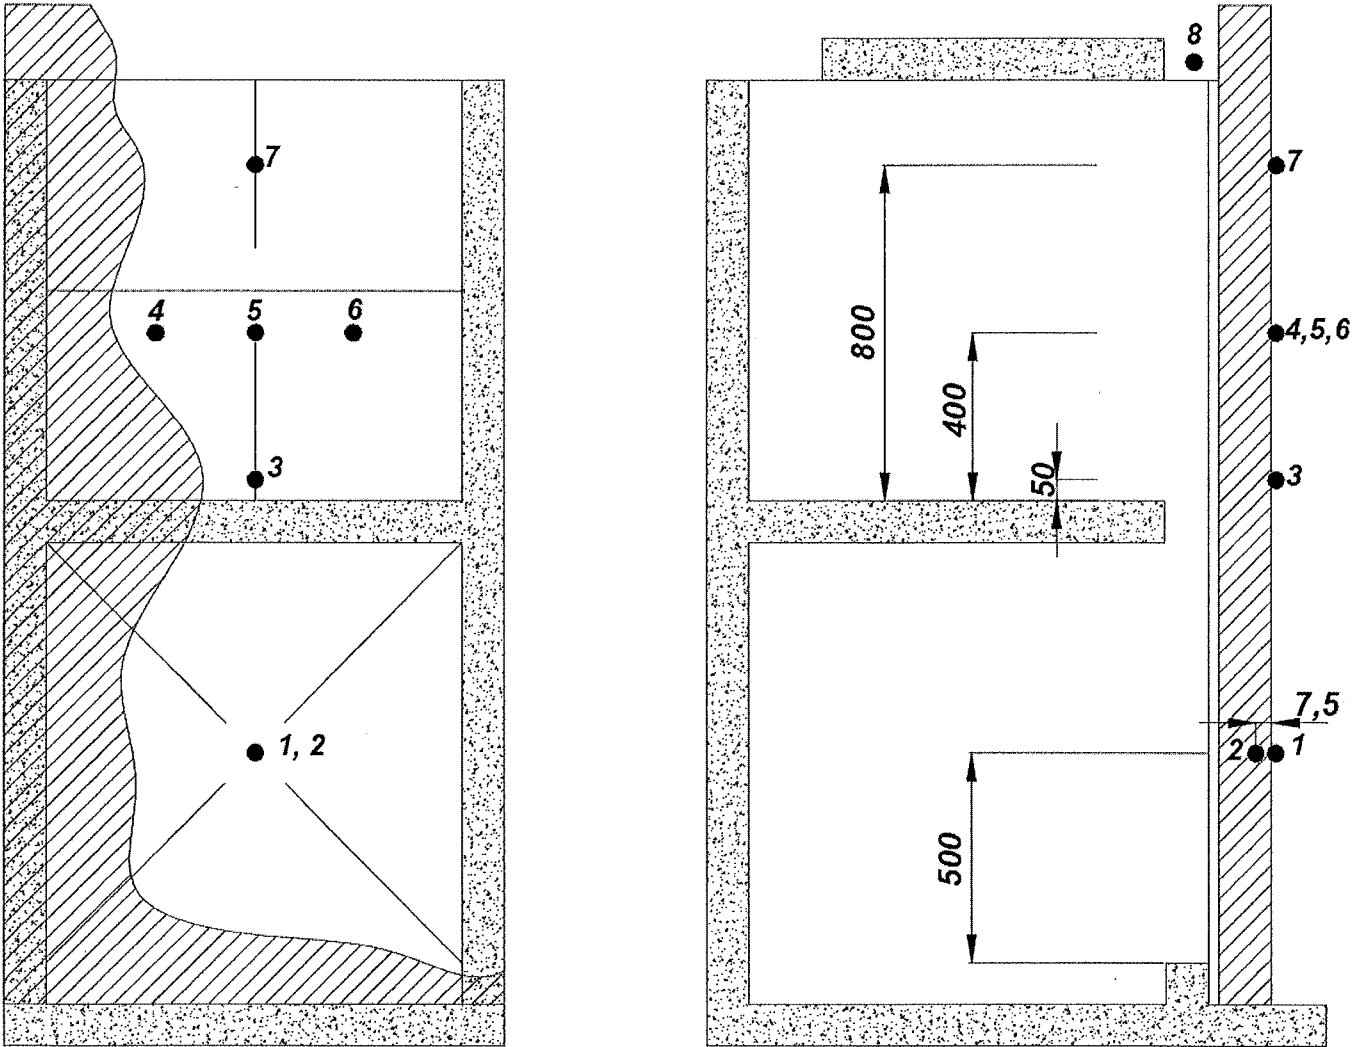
Схема печи (установки) для испытаний вертикальных конструкций на пожарную опасность, установки на ней образца конструкции и расстановки термомпар на образце.
